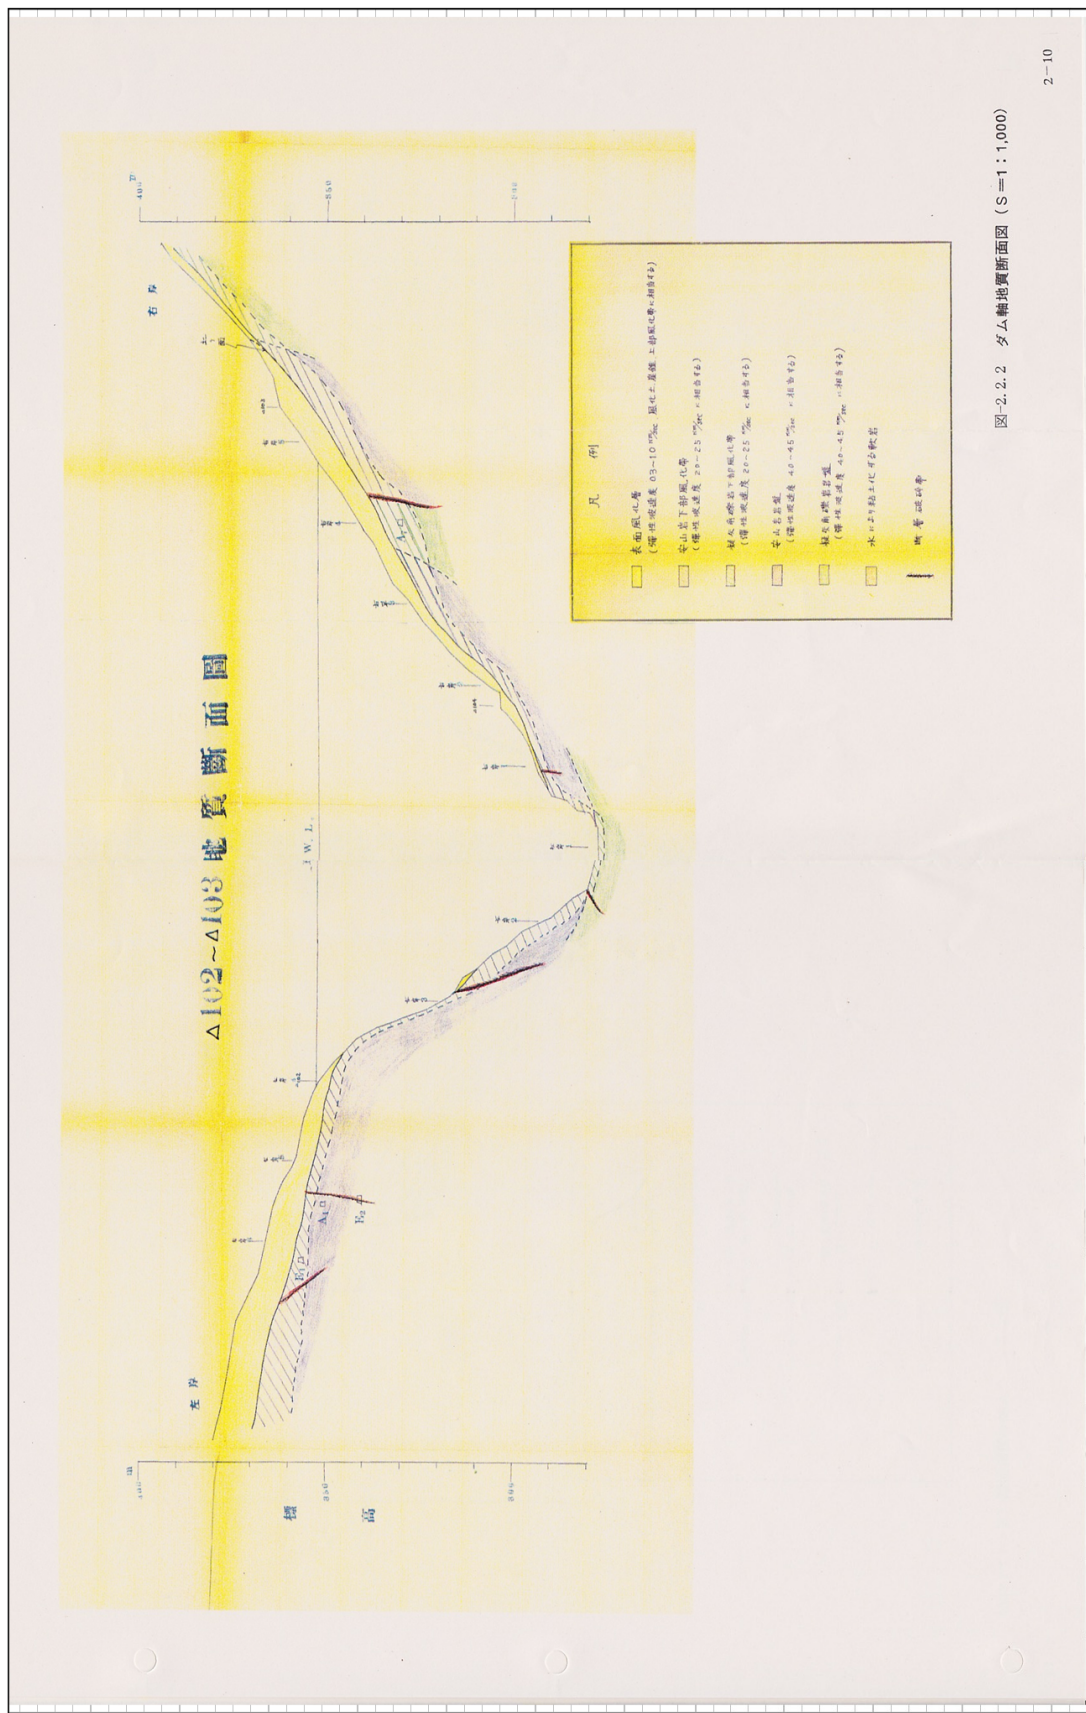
ダム軸地質断面図 (S=1:1,000)
